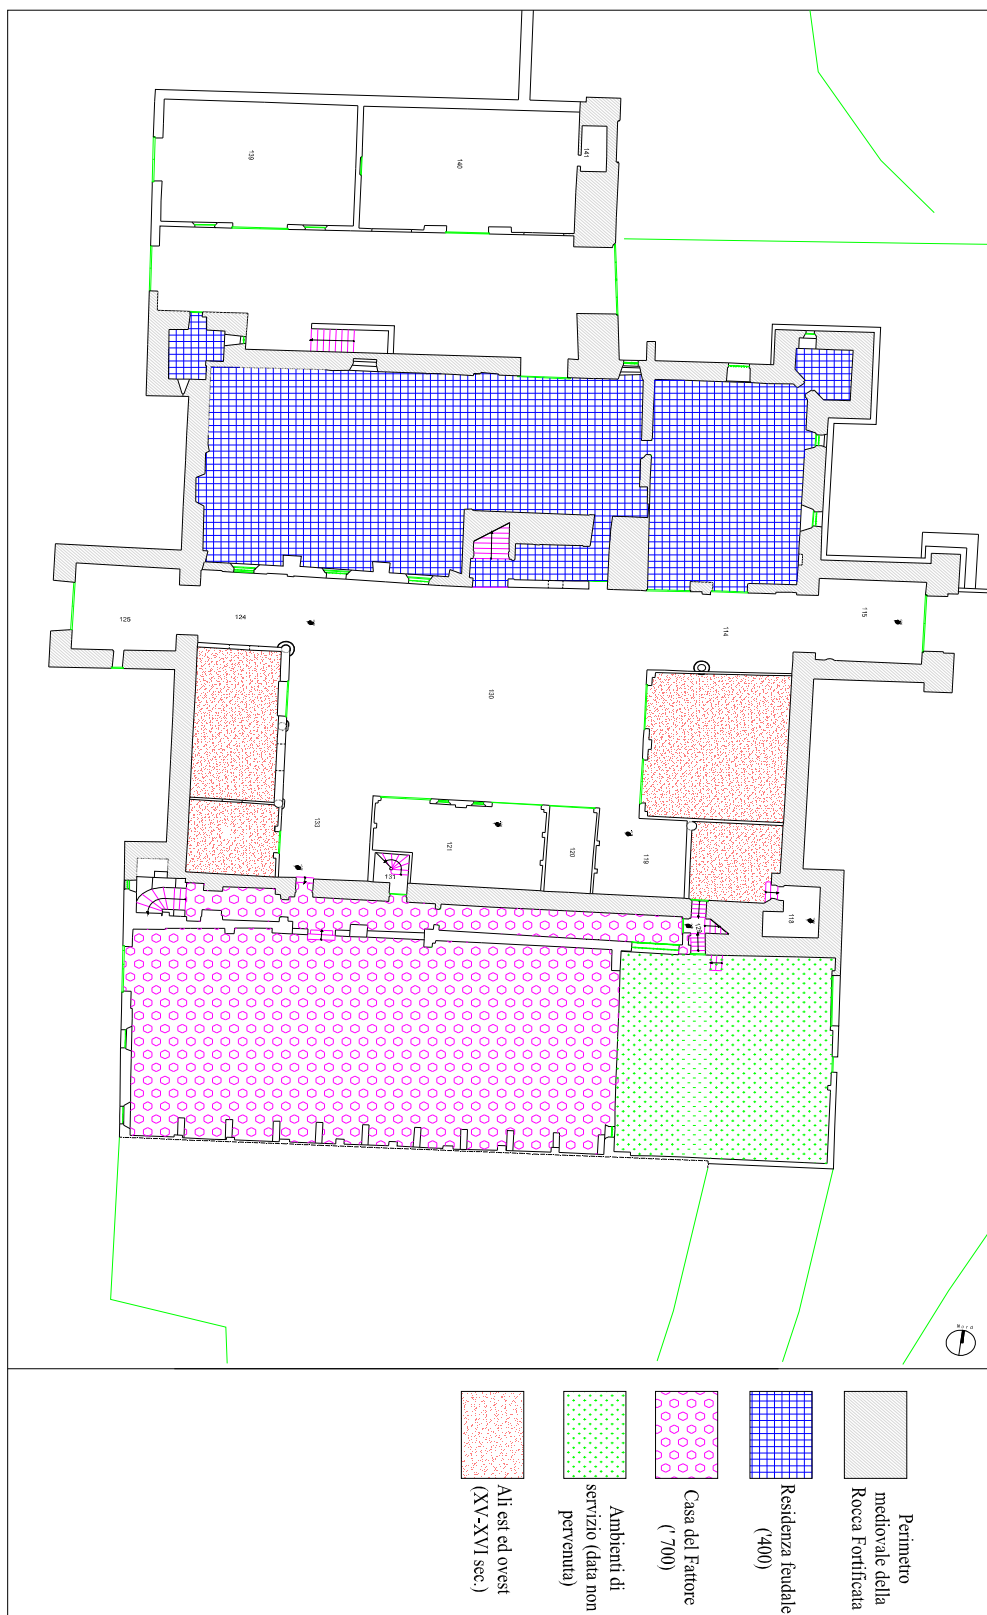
Planimetria delle fasi costruttive al piano terra
